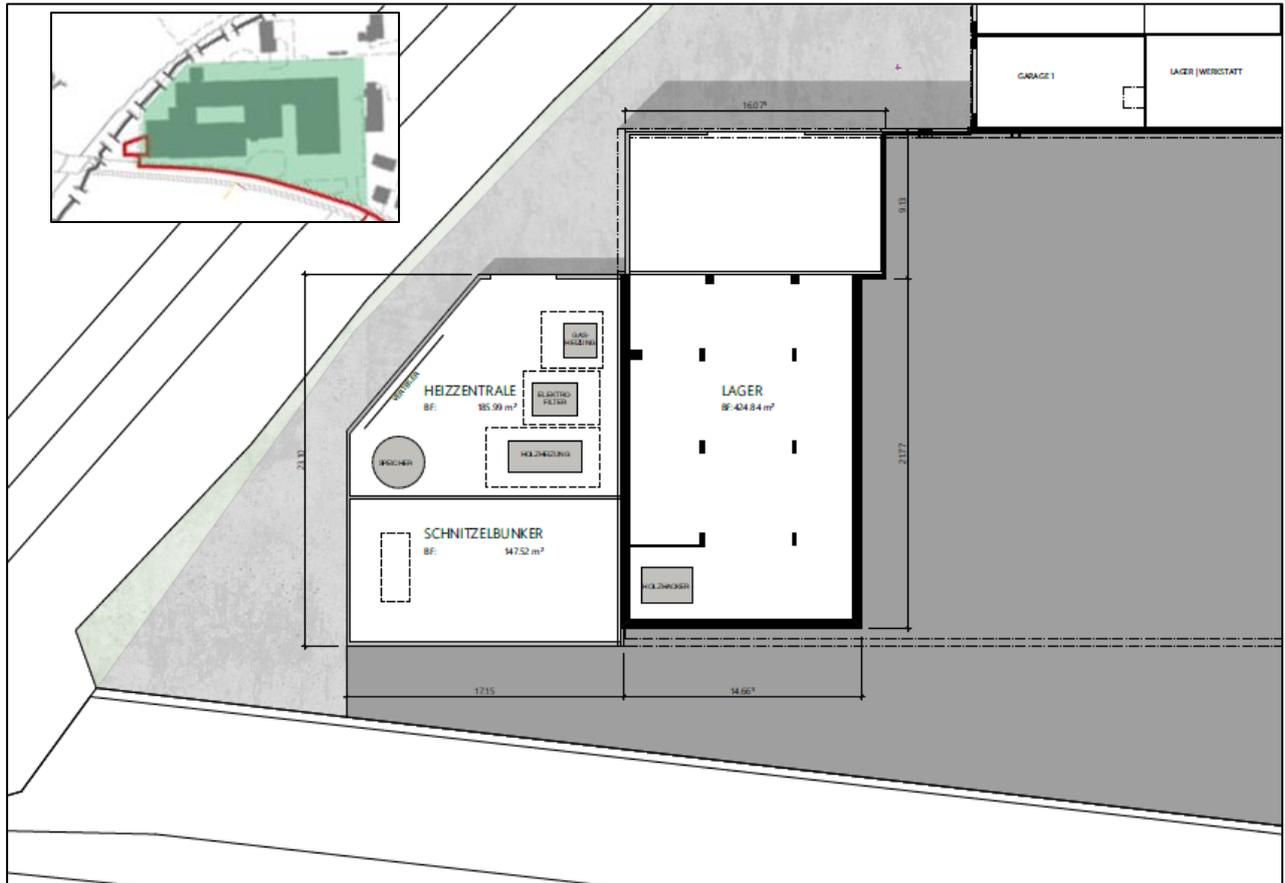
Ausschnitt Layout Heizzentrale S. Müller Holzbau (Projektstand 31.01.2022)
